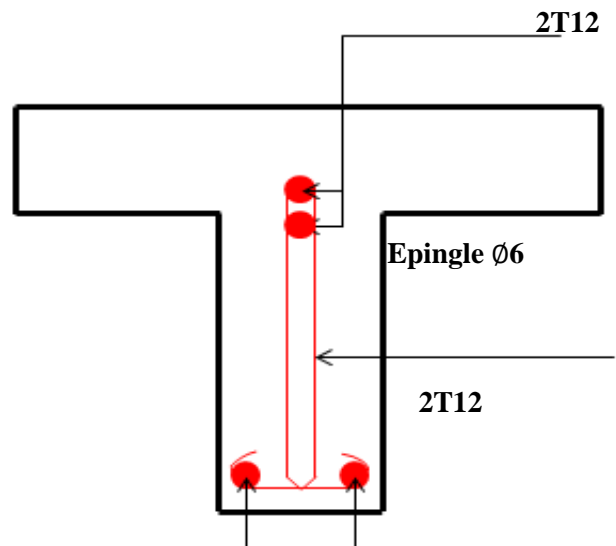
Schéma de ferrailage des poutrelles pour l'appui et le travée
